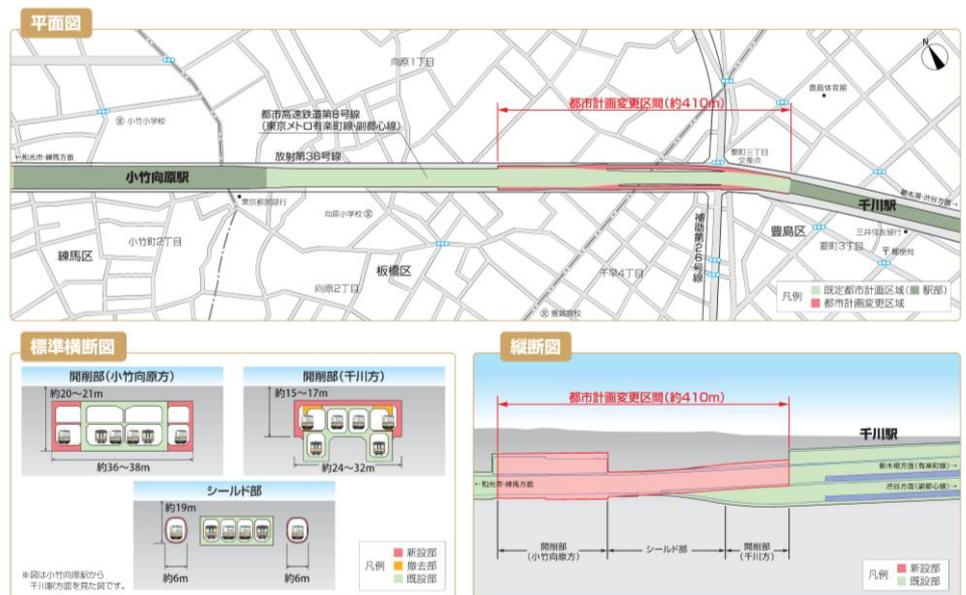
計画概要図 (平面図, 横断面図, 縦断面図)
